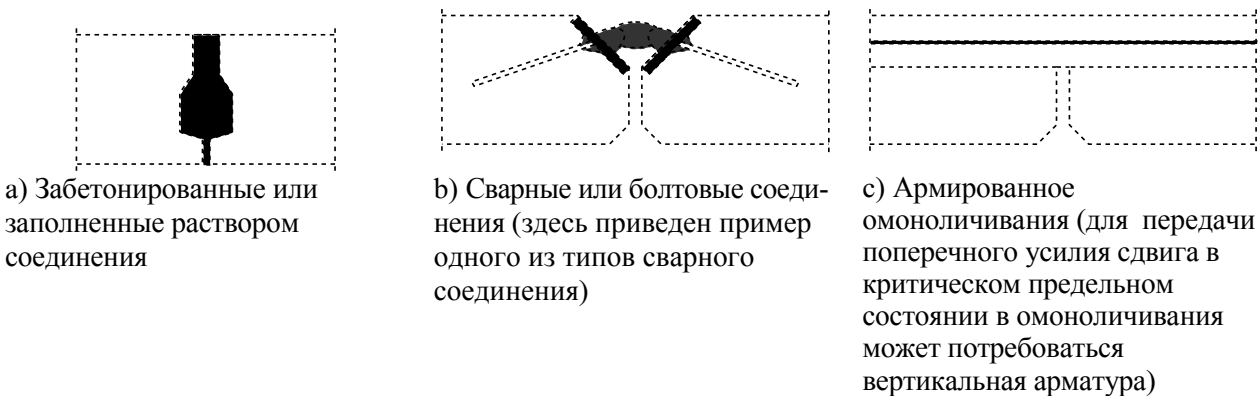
Примеры соединений для передачи поперечной силы
